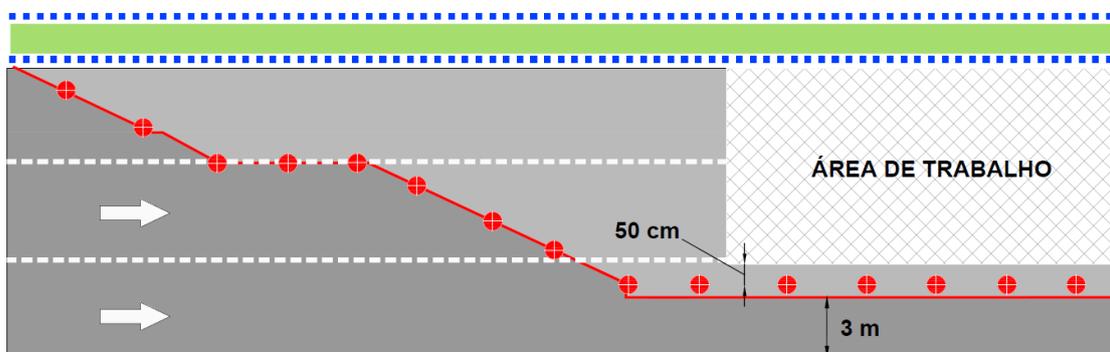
Posicionamento de dispositivos de canalização – Pista com 3 Faixas (caso 2)
